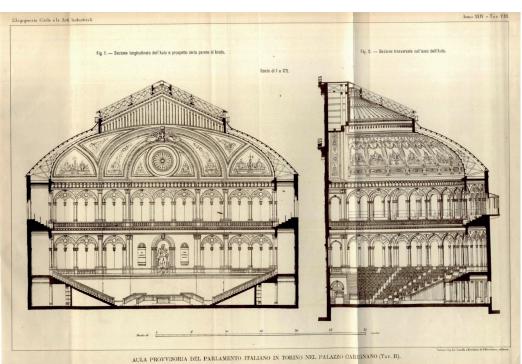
Sezione longitudinale e trasversale dell'aula provvisoria. Fonte: Pulciano 1898, Tav. II.
